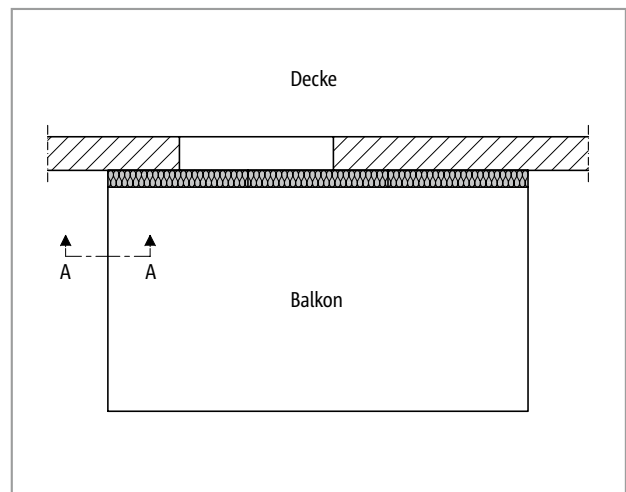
Schöck Isokorb® XT Typ K: Darstellung der Lage von dem Schnitt A-A
